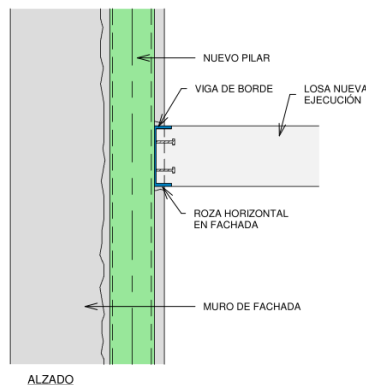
Estructura metálica adicional en fachadas del ala Este inserta dentro de los muros de carga
